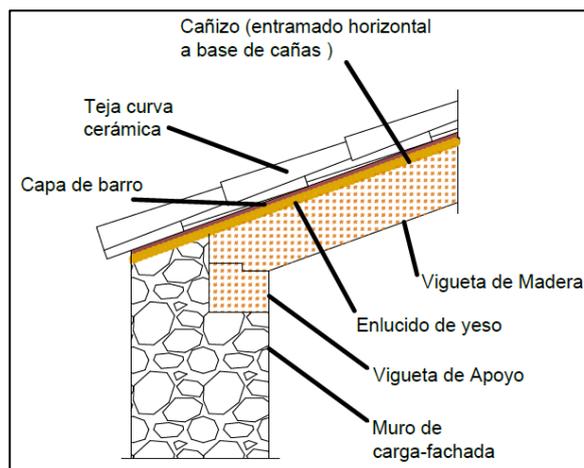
Detalle encuentro cubierta y muro. Fuente propia
